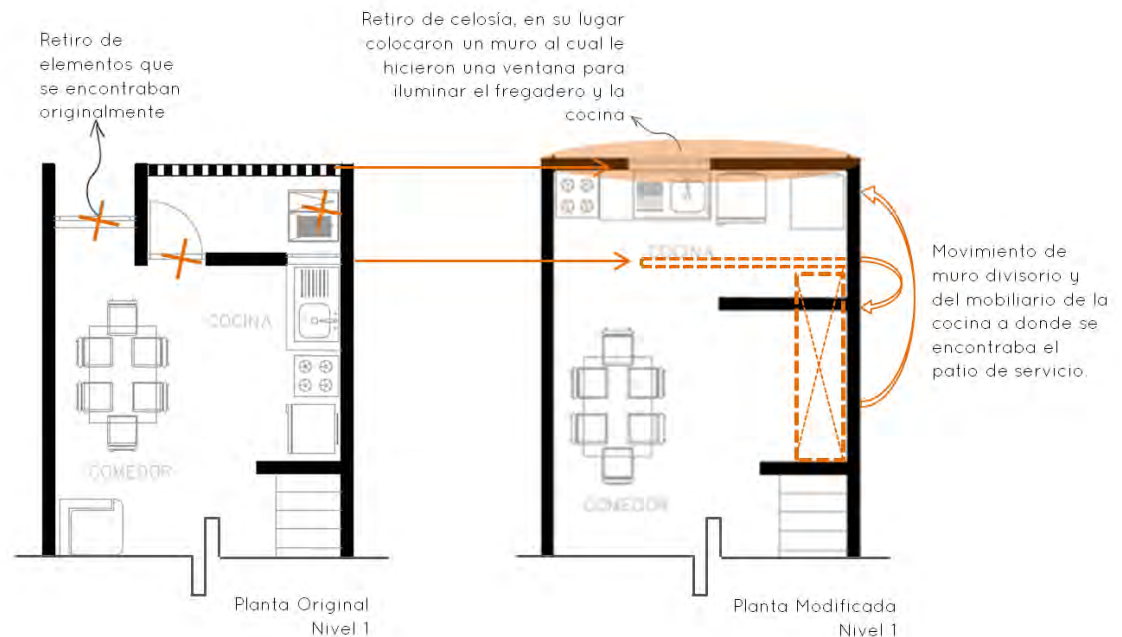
Planta actual comparada con la original, indicando con color las modificaciones y elementos que cambiaron en el área de cocina y comedor. Fuente: Propia 2018
